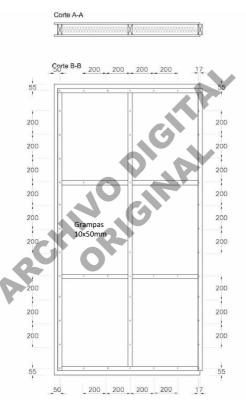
Detalle de engrapado para ensamblado de paneles (corte). Fuente: Ñandé, 2021.
